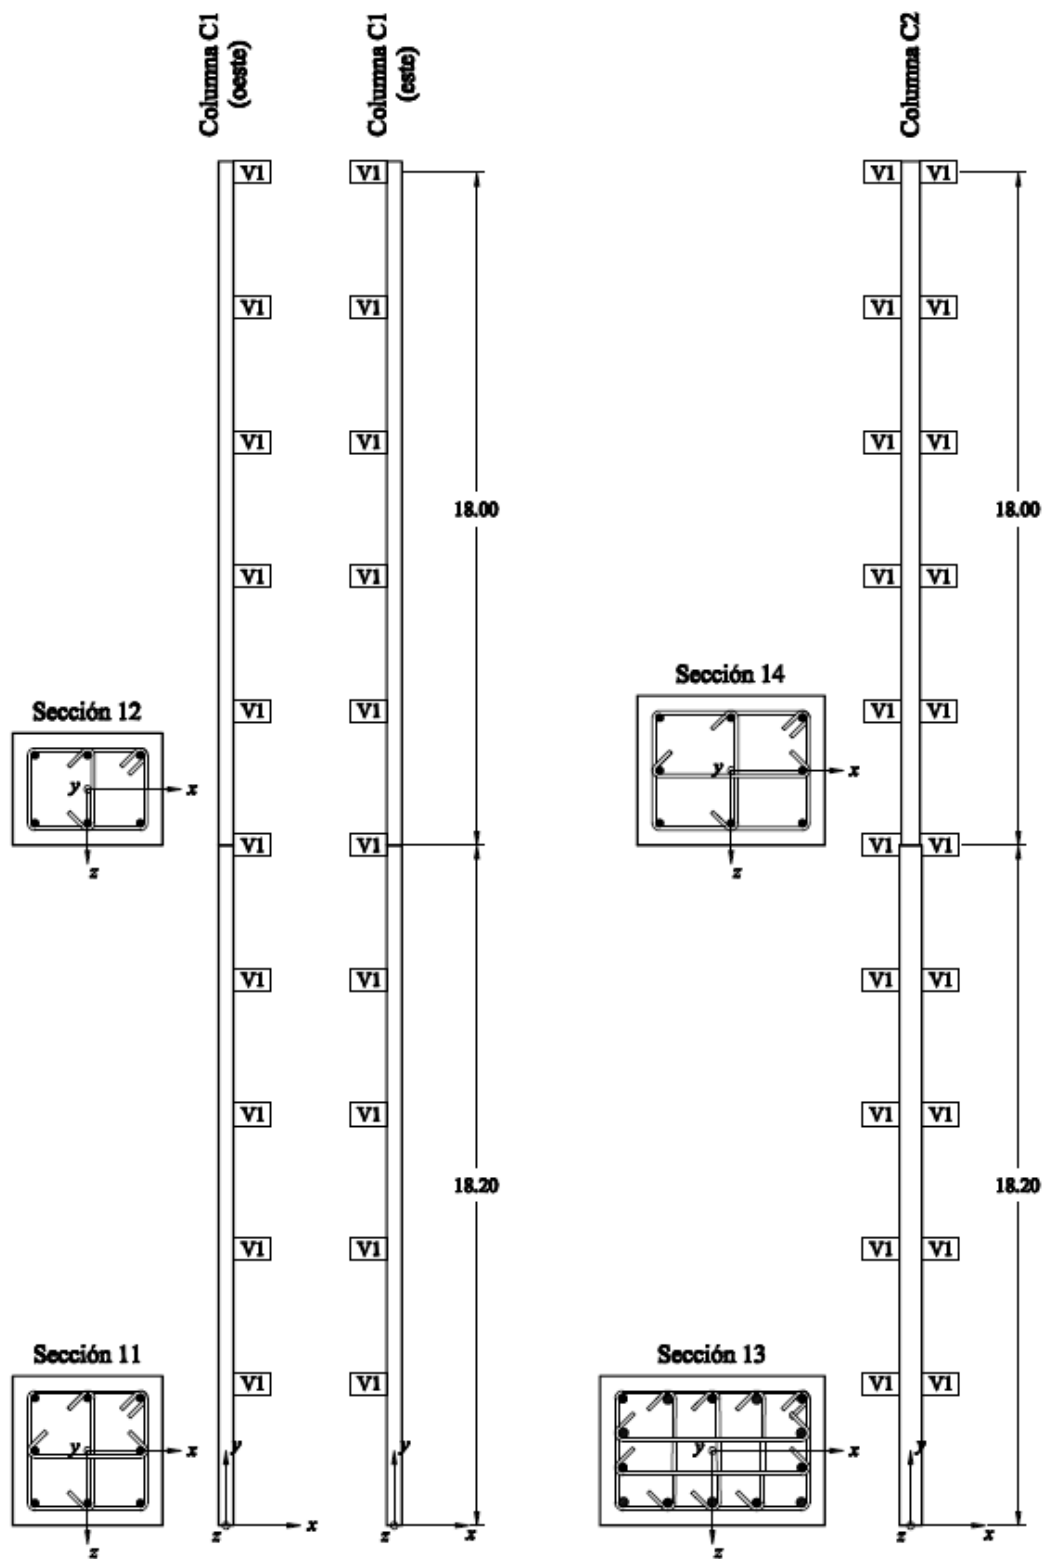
Columnas C1 y C2| Vista de Elevación (Unidades en m)
